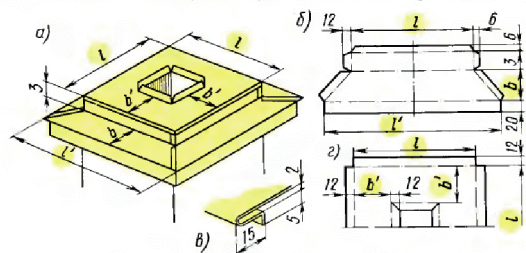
Заготовка колпака дымовой трубы: а — колпак, собранный на оголовке трубы; б — заготовка боковины; в — капельник; з — заготовка крышки; размеры l и b' — оголовка, b и l' — основания колпака
